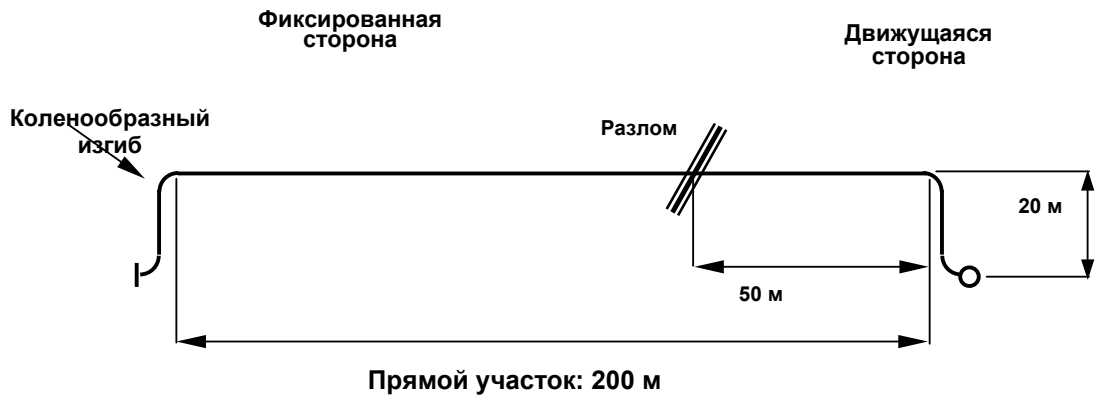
Схема участка трубопровода пересекающего разлом
